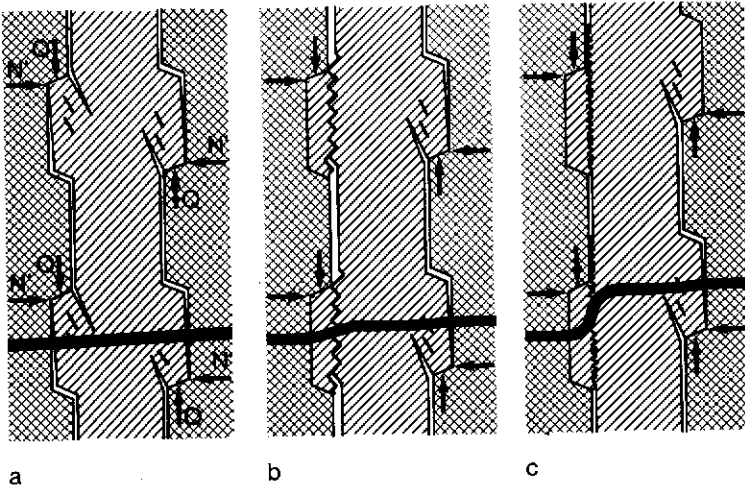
Et typisk etagekryds mellem betondæk og -vægelementer rummer fire forskellige langsgående støbeskel:
